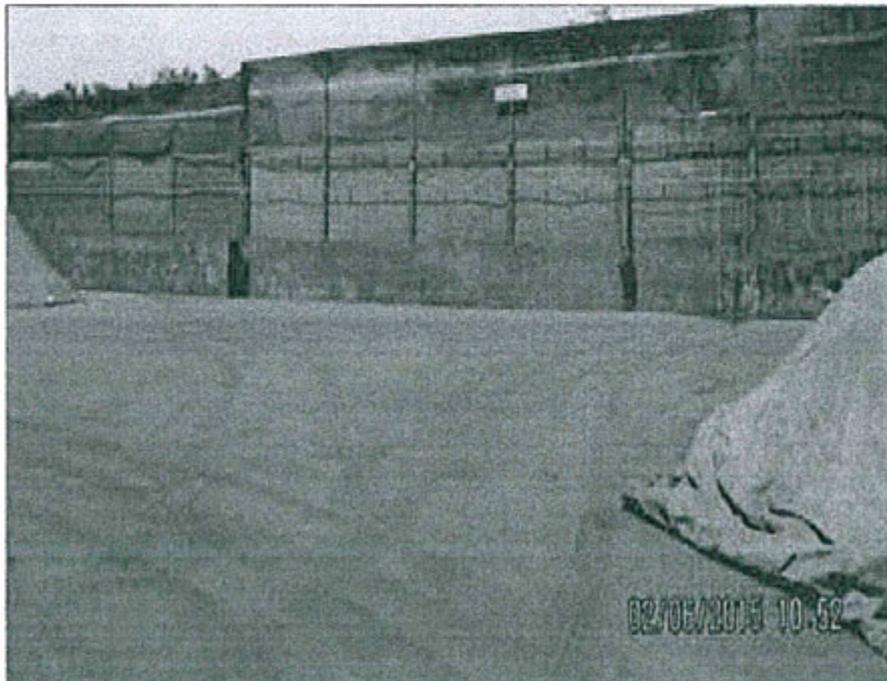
Patio N° 2 donde se muestran las mallas rachel, instaladas sobre el muro perimétrico, debidamente instaladas y en óptimas condiciones
